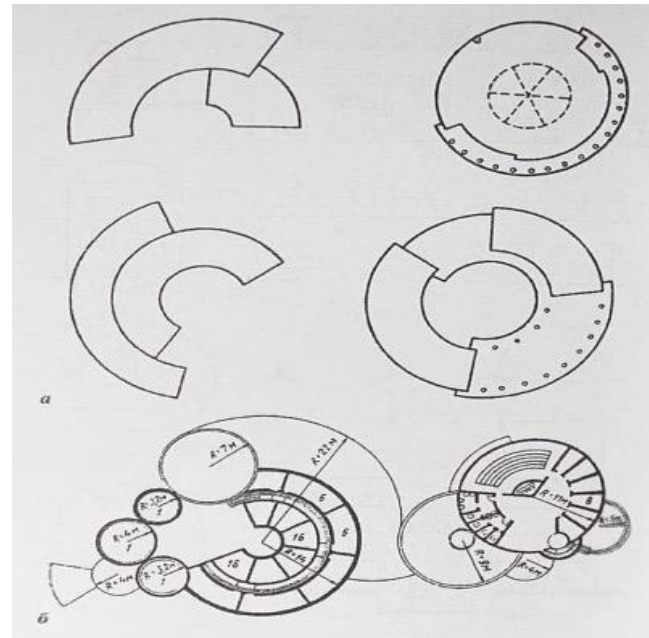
Нові типи виробничих будівель. Будівлі на криволінійній планувальній основі: а - нові типи виробничих будівель; б - експериментальне рішення виробничої споруди - план типового поверху. [1]
